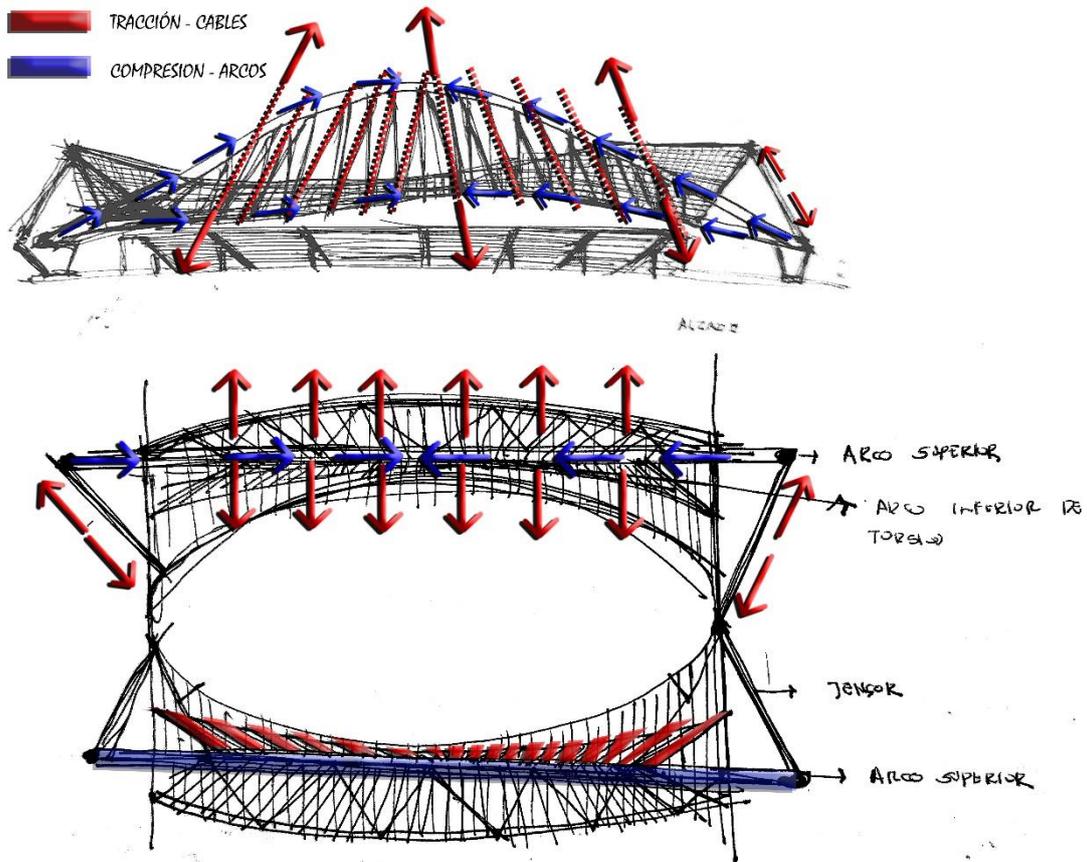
"Gráfico de fuerzas: planta y alzado"
